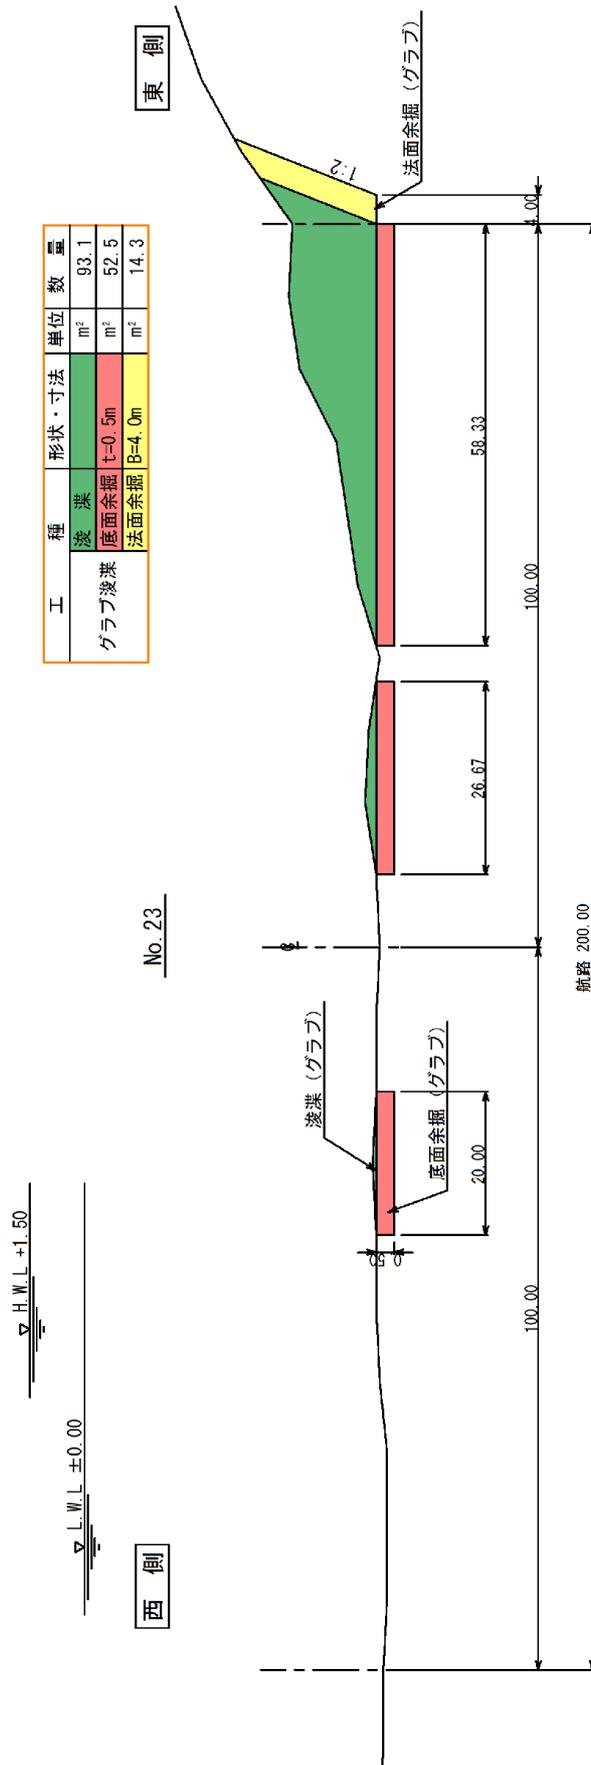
No.1 大洗港区_中央地区航路 (-8m) の断面図 (復旧後)
